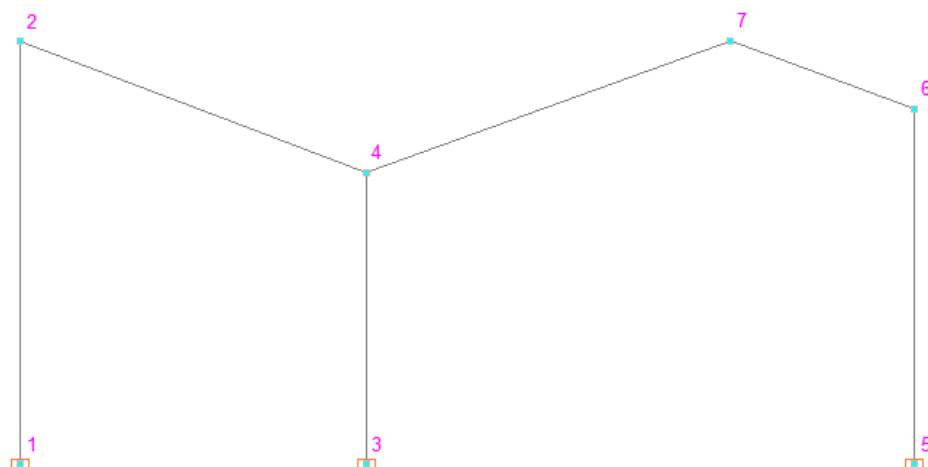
Расчетная схема поперечной рамы в осях 12/И-В
